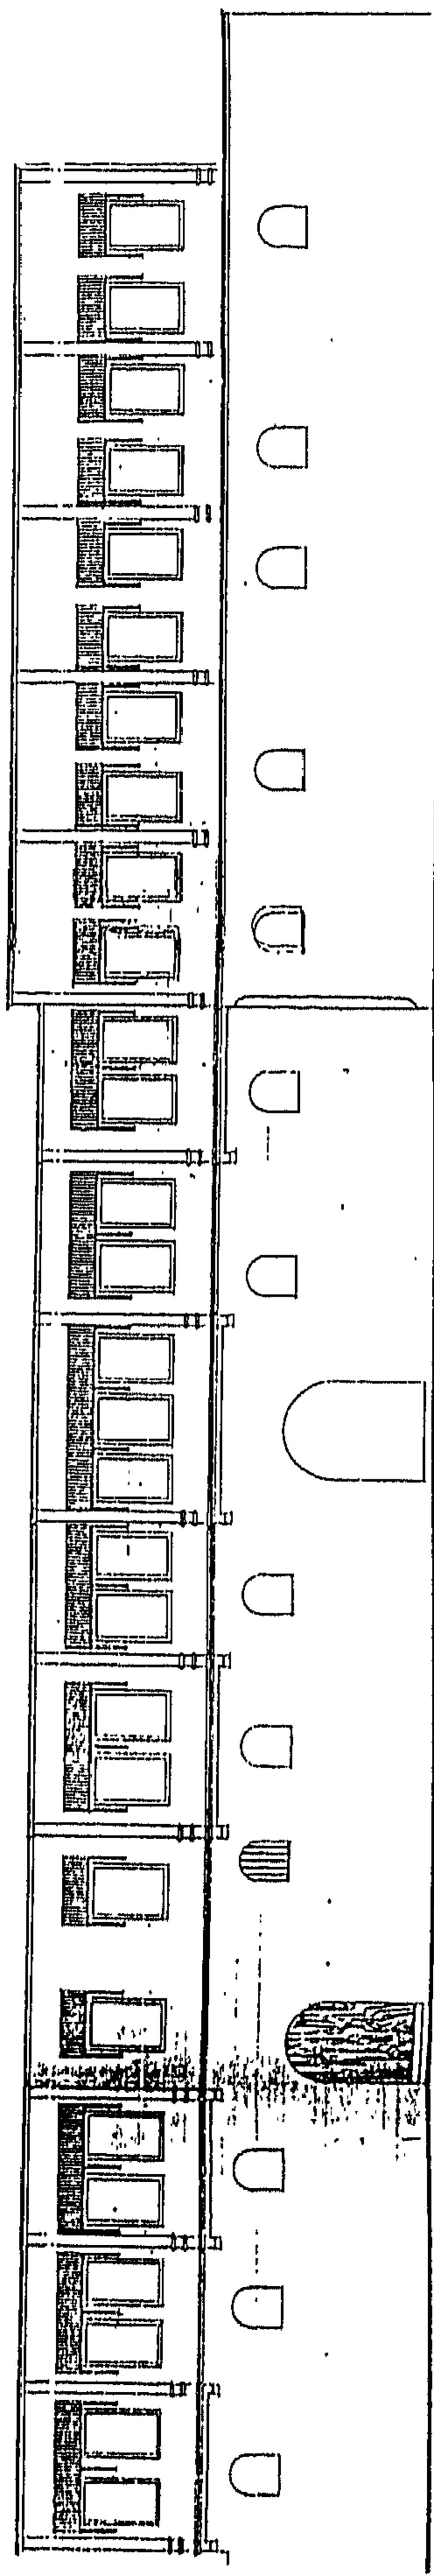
مسقط أفقي تخيلي لما كان عليه الدور الأول من مدرسة القلعة .
